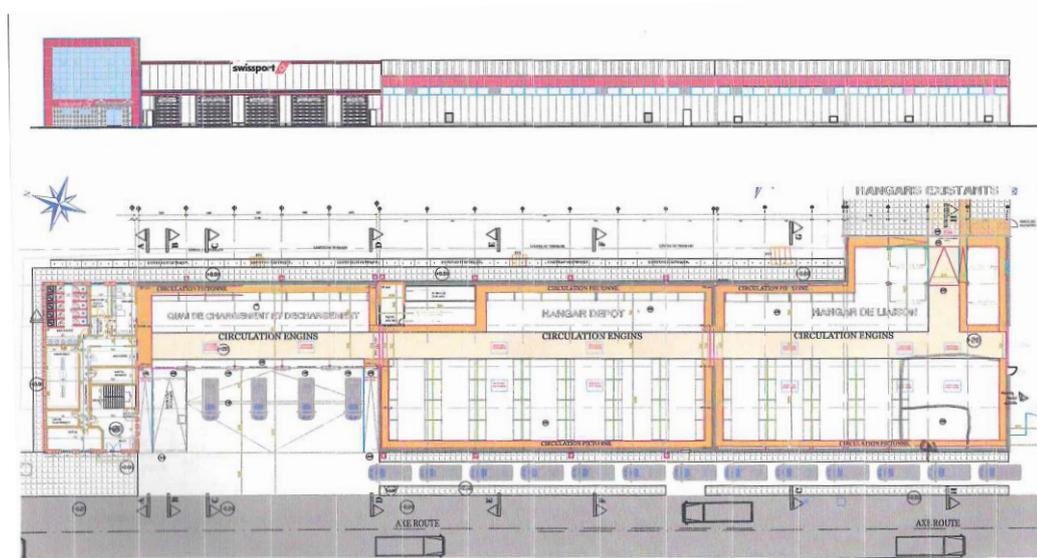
Plan d'une partie de l'entrepôt EK (zone break-down et zone pick-up)
